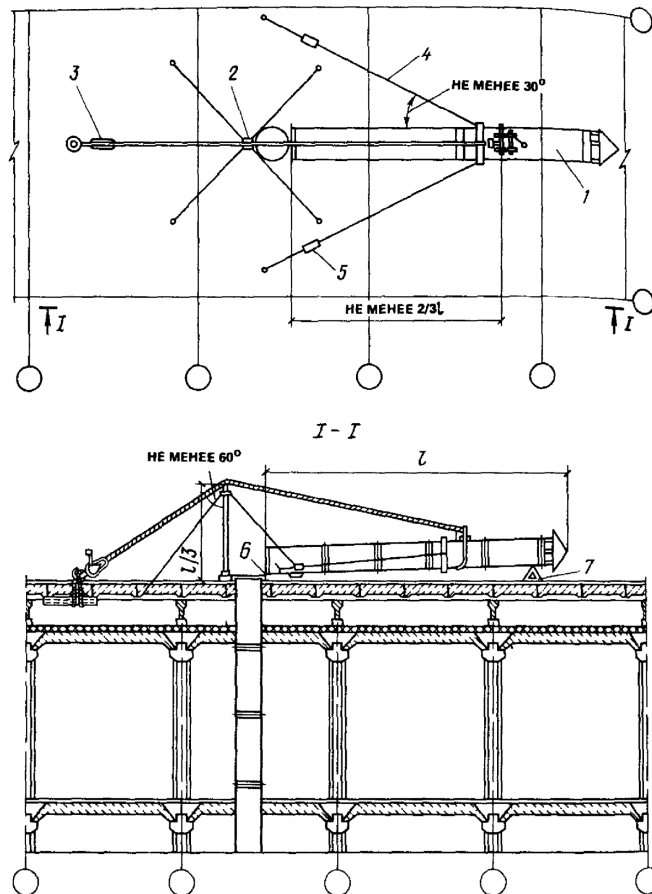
Схема организации рабочей зоны при монтаже вертикальных воздуховодов на кровле здания с помощью мачты: 1 - воздуховод; 2 - мачта; 3 - монтажно-тяговый механизм; 4 - растяжка; 5 - талреп; 6 - шарнир; 7 - подставка
